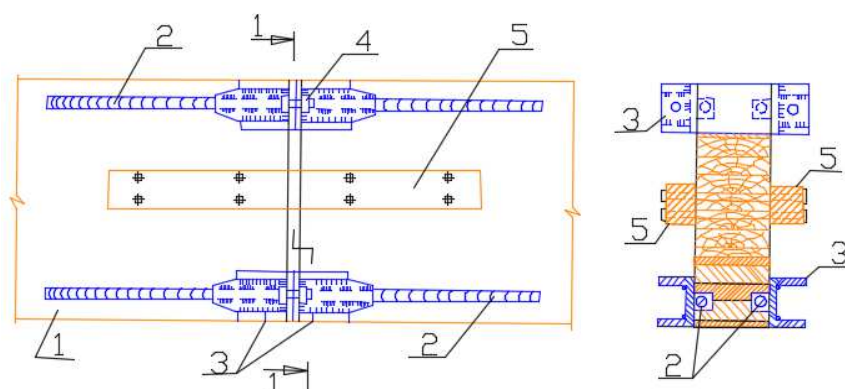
Монтажный узел клееной арки (НИСИ): 1 – элементы арки; 2 – вклеенные стержни; 3 – сварные башмаки; 4 – стяжные болты; 5 – накладки
